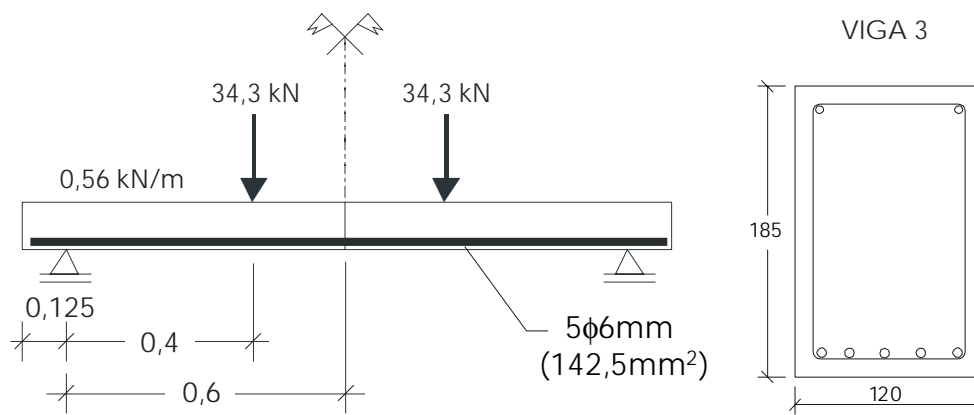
Esquema estático, dimensões e carregamento da VIGA 3
